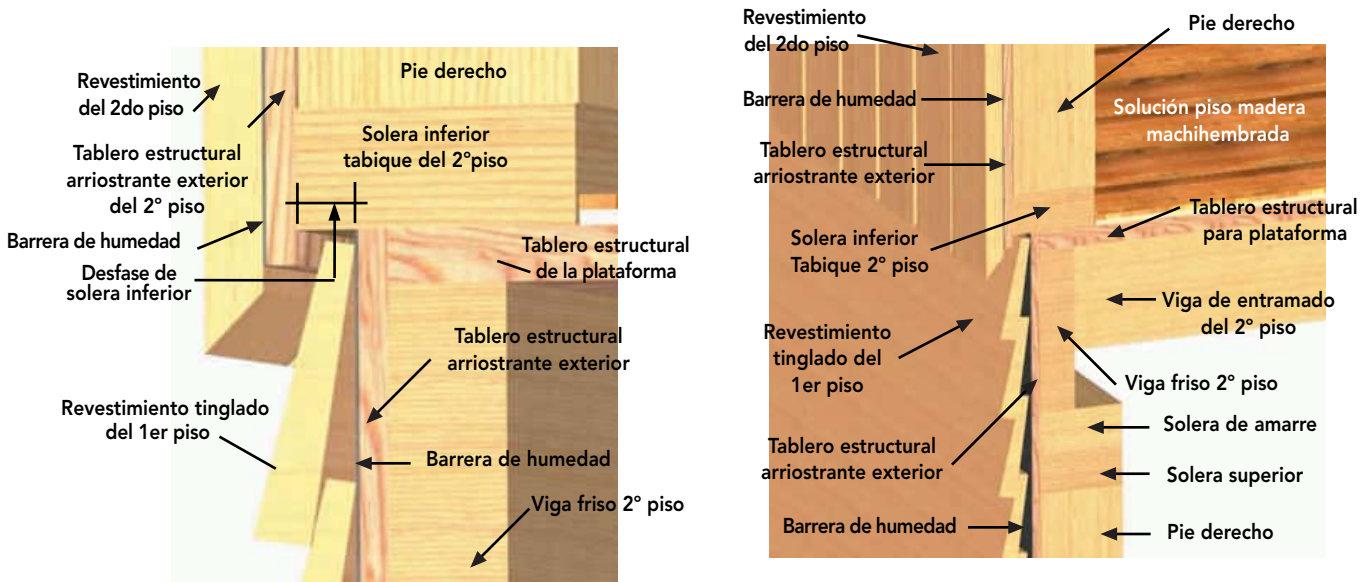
13: Detalle de solución constructiva para el encuentro del revestimiento entre dos niveles, desfasando la solera inferior de los tabiques perimetrales del segundo piso. Corte y vista en perspectiva del muro exterior con el revestimiento instalado.
